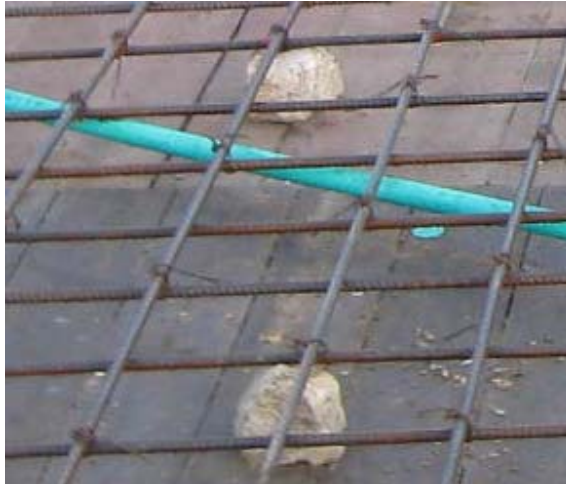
Colocación de “panelas” de concreto para garantizar recubrimiento
